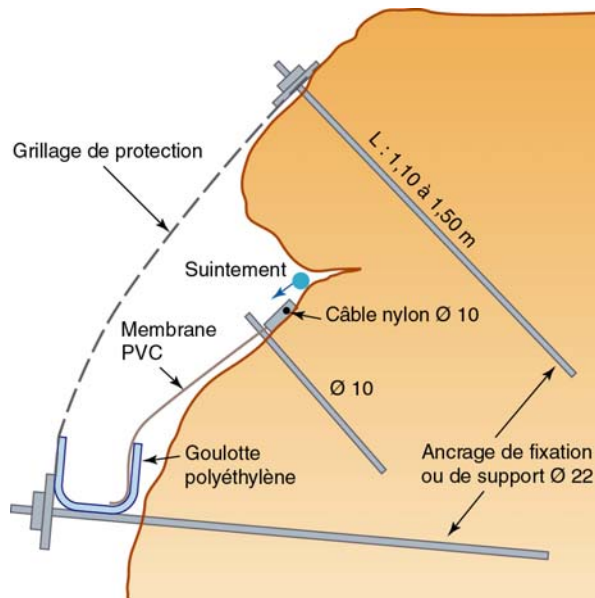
1 Exemple de dispositif de collecte des eaux de paroi (descente des Ergratz, Haute-Savoie). D'après [DRM]
